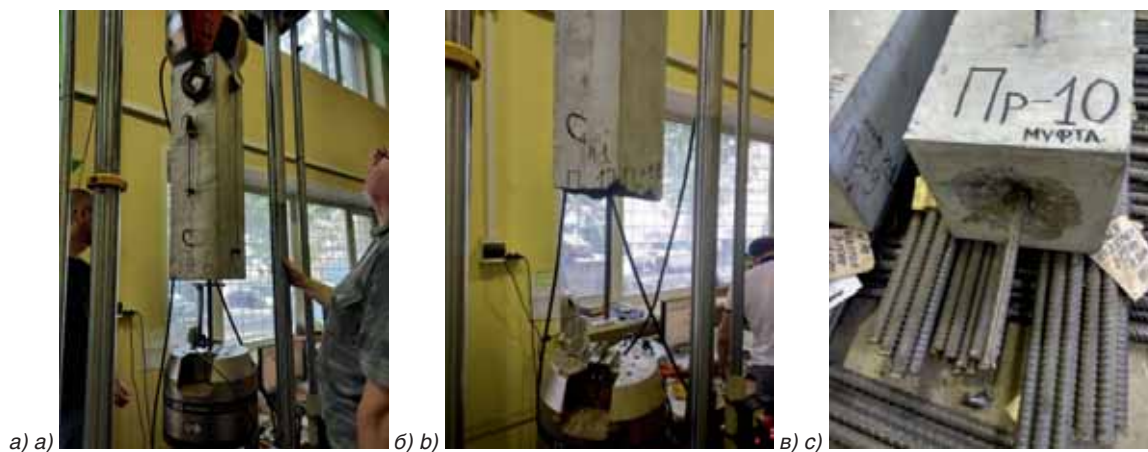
Растяжение арматуры, забетонированной в центре призмы:
